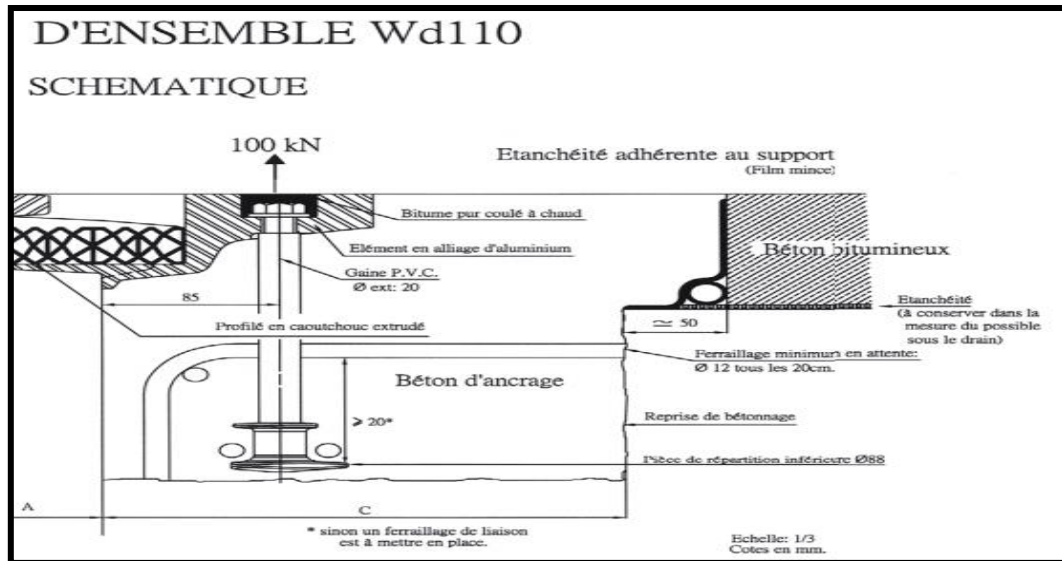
Caractéristique du joint de chaussée Wd110
